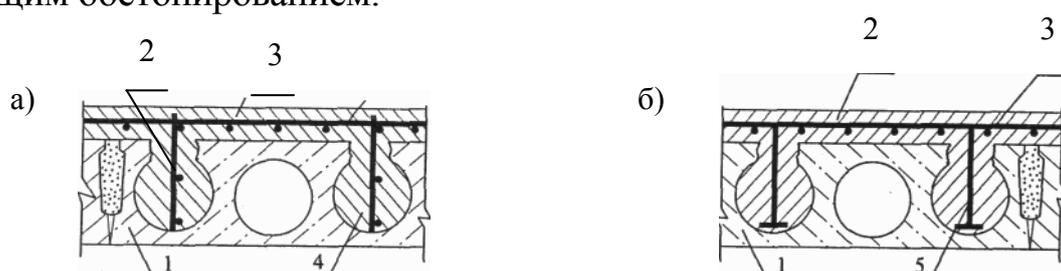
Усиление сборной многопустотной плиты перекрытия: *а* – с применением арматуры периодического профиля; *б* – с применением жесткой арматуры из прокатного профиля; 1 – существующая плита; 2 – монолитный бетон; 3 – горизонтальное армирование усиления; 4 – вертикальные каркасы усиления; 5 – прокатные двутавровые балки в качестве арматуры усиления
